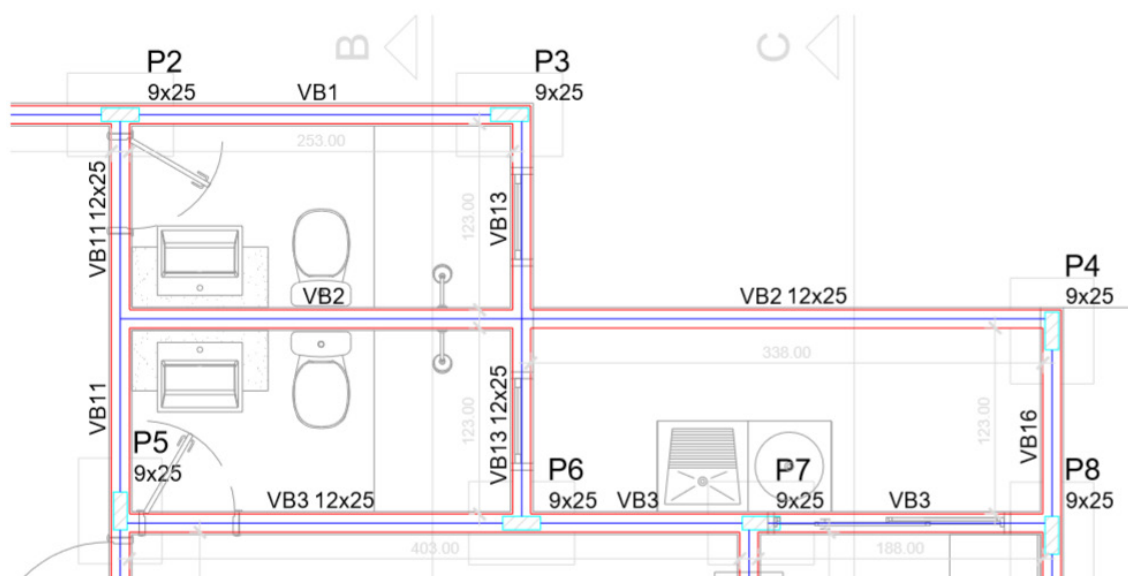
Vigas Baldrame (Adaptada pelo autor)
